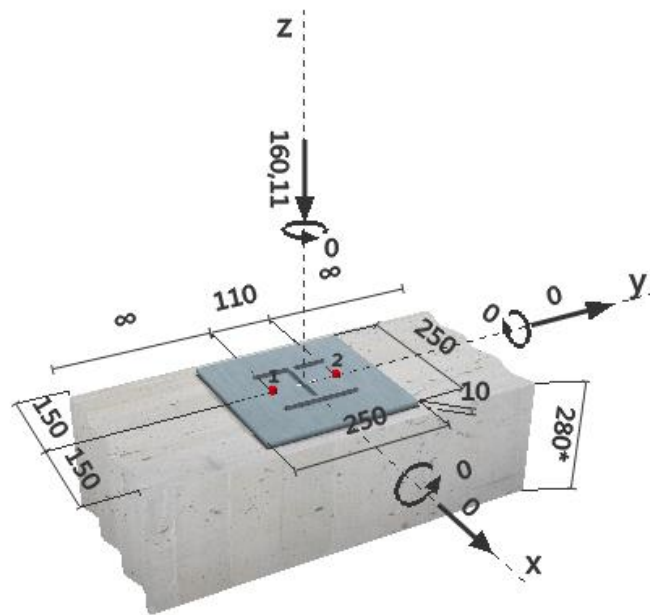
Esquema de ligação do perfil metálico à viga (Hilti PROFIS Anchor 2.4.3)
